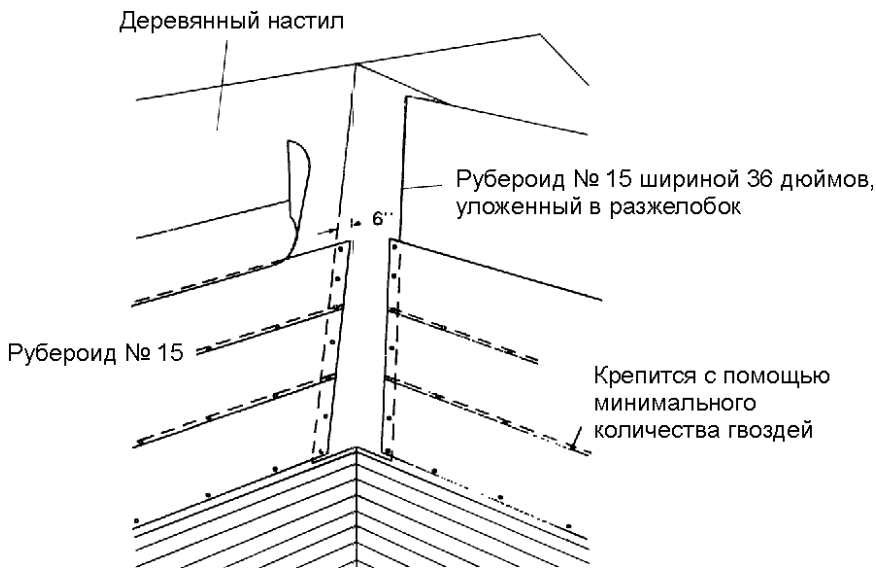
Подложка из рубероида, уложенная в разжелобок перед укладкой кровли разжелобка (Bird and Son)
